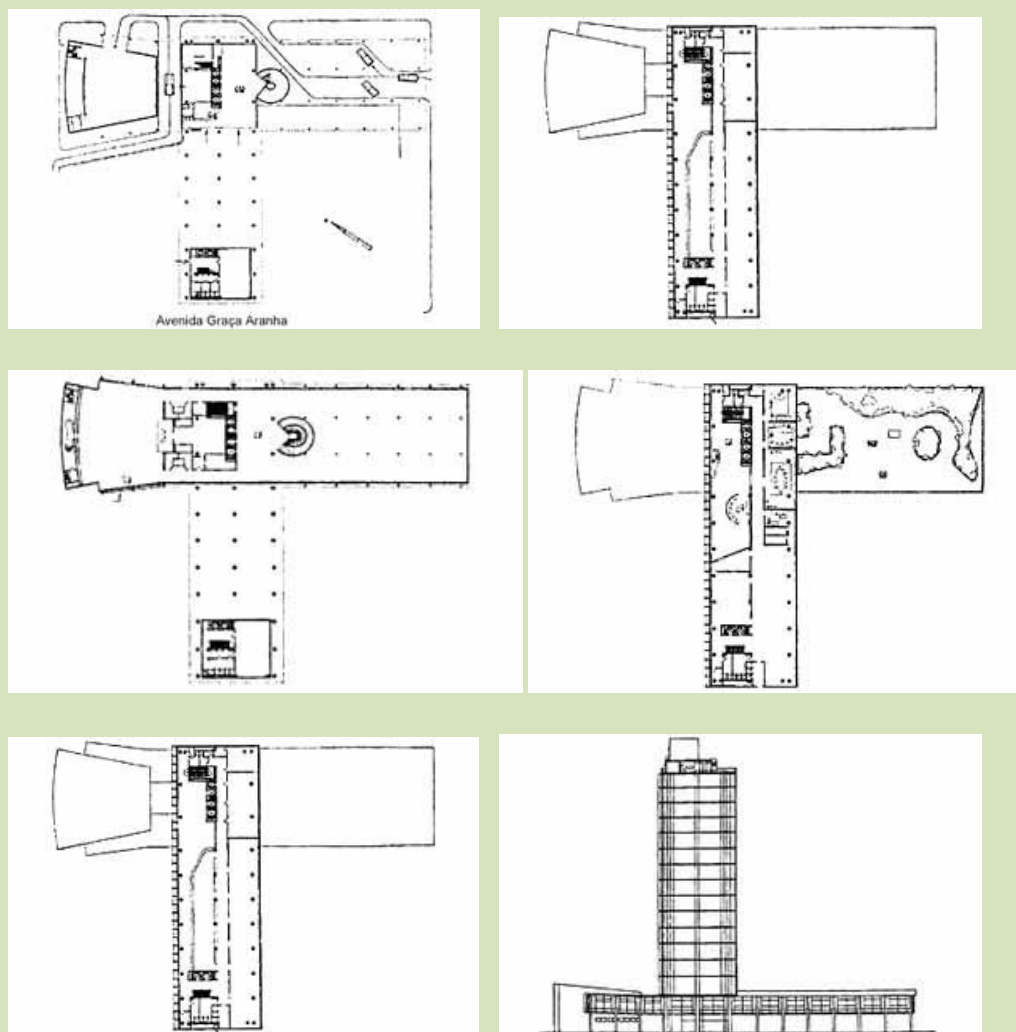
Plantas dos pavimentos e Corte do Edifício Sede do Ministério da Educação e Saúde, Rio de Janeiro, RJ Fonte: (ARCOWEB, 2008)
